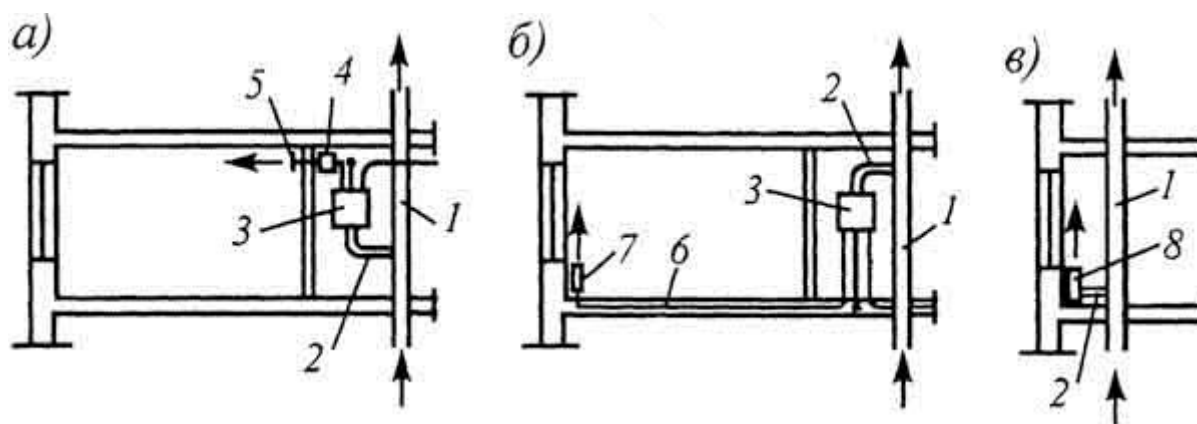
Схемы комбинированного отопления многоэтажных зданий с централизованной подачей подогретого воздуха и местным дополнительным нагреванием: а - в групповом нагревателе для выпуска воздуха под потолком помещений; б - то же, для выпуска воздуха под окнами помещений; в - в индивидуальном нагревателе-доводчике под окном каждого помещения; 1 - распределительный воздуховод; 2 - ответвление; 3 - групповой воздуheонагреватель; 4 - шумоглушитель; 5, 7 - регулятор подачи воздуха; 6 - подвесной воздуховод; 8 -нагреватель - доводчик
